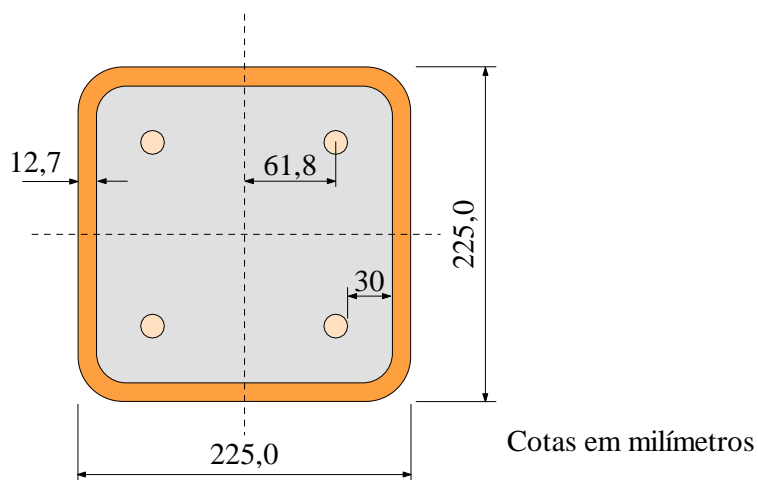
Distribuição da armadura na seção TR 225,0 × 225,0 × 12,7
